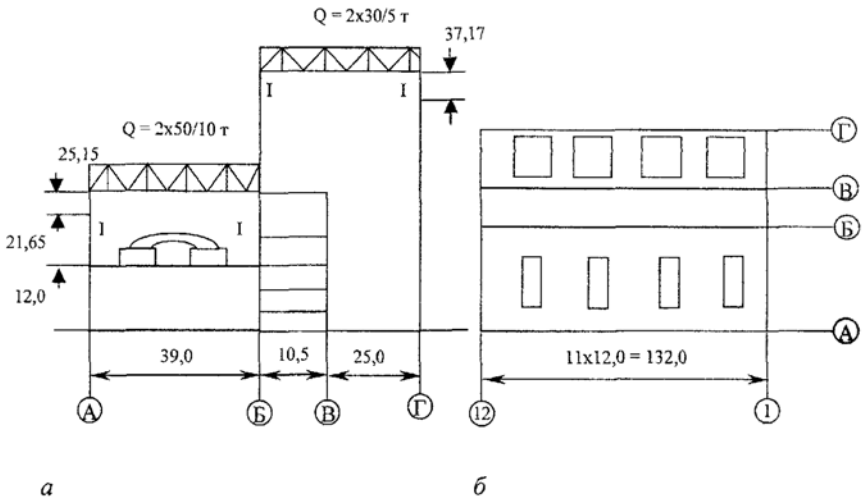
Главный корпус гаомазутной ТЭЦ ЗИГМ: а – разрез ГК; б – план ГК
